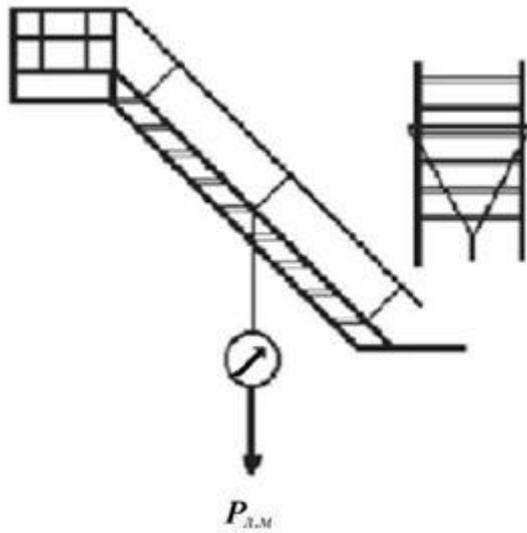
Схема приложения испытательной нагрузки для лестничного марша
